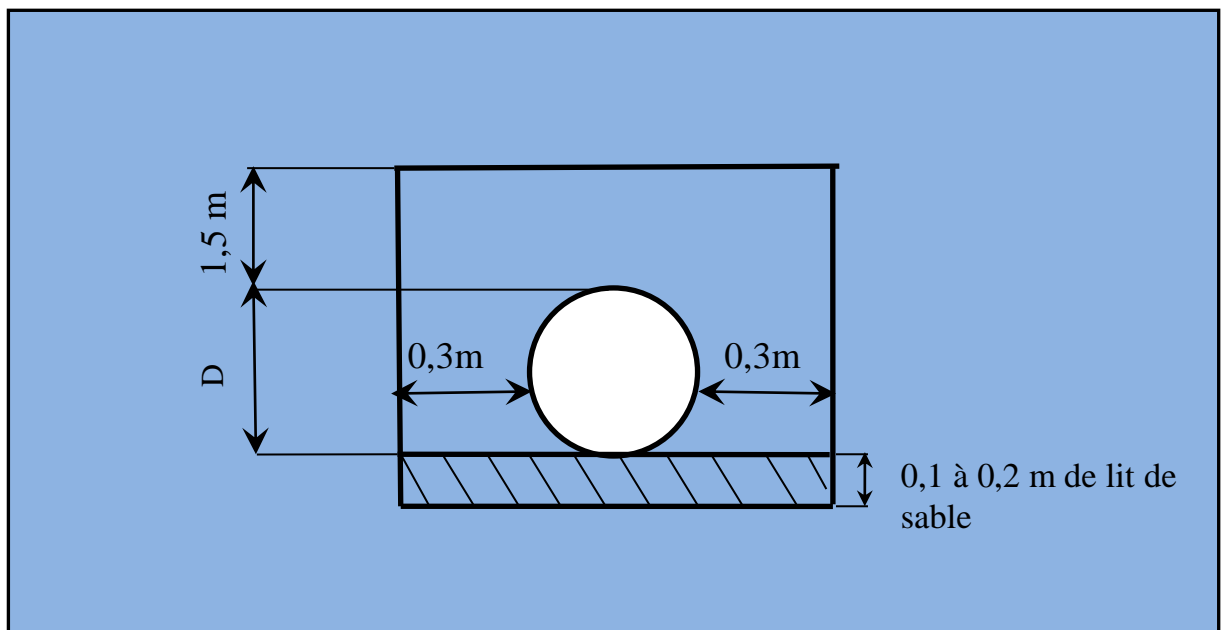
Schéma simplifié pour place la conduite d'adduction
